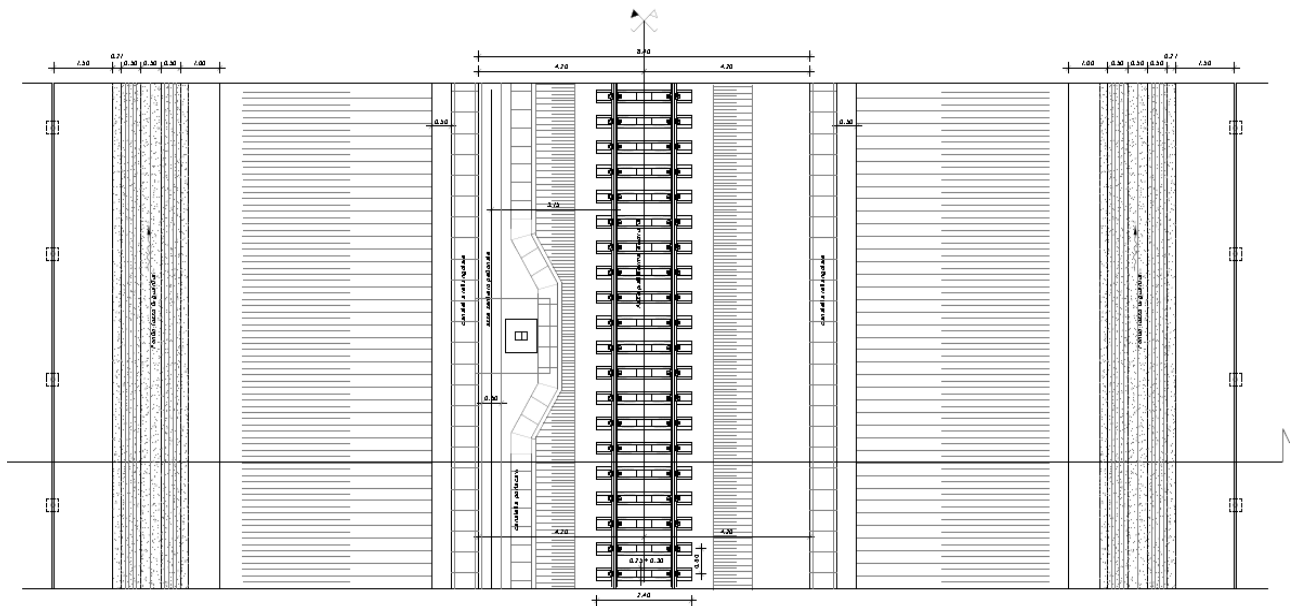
Stralcio planimetrico con sezione tipo ferroviaria in trincea a singolo binario in rettilo
